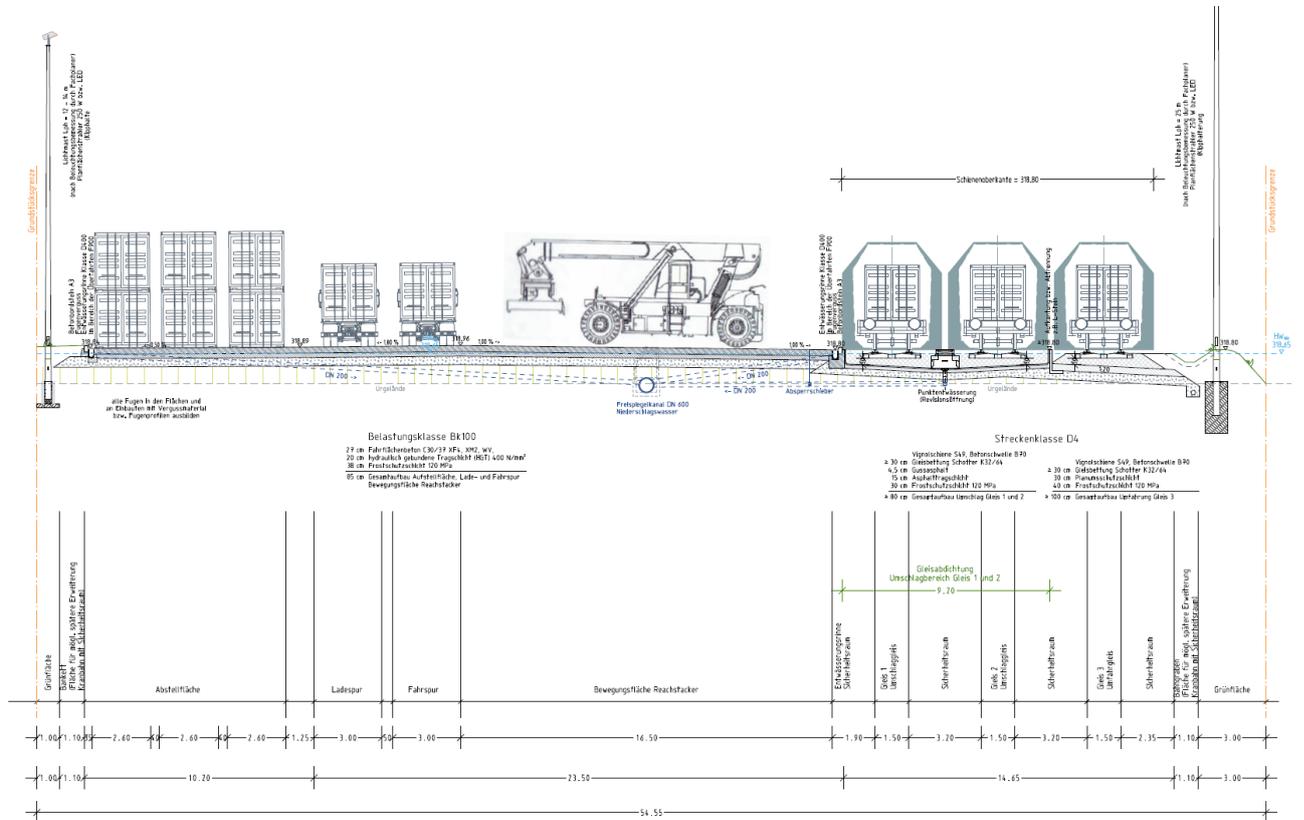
Querschnitt Ausbaustufe 1 - Plan 2469_A08_2_1_Q2f_Querschnitt_Terminal
